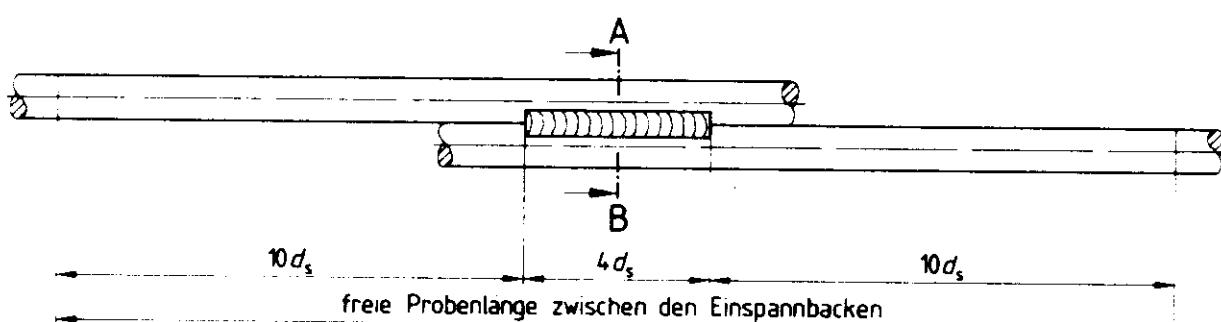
Zugprobe für Baustellenschweißungen (Schnitt A–B siehe Bild 1)
